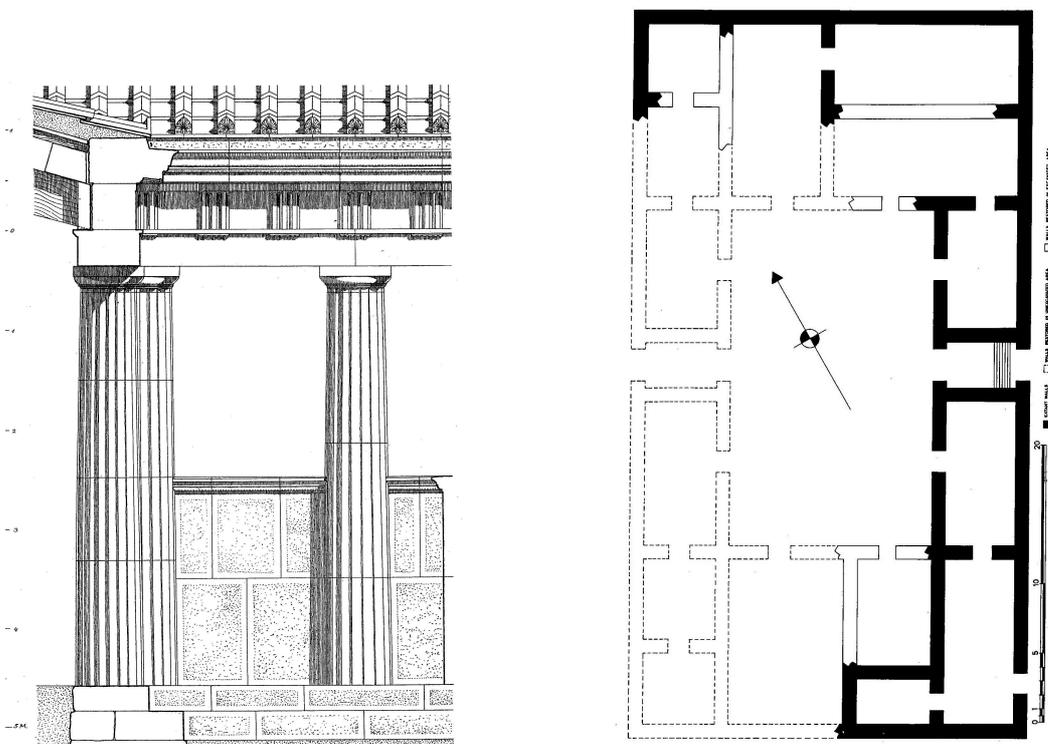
Der W-Flügel der Hafenhalle mit den Schranken (links) und der Grundriss des sogen. Gneisgebäudes (rechts).
